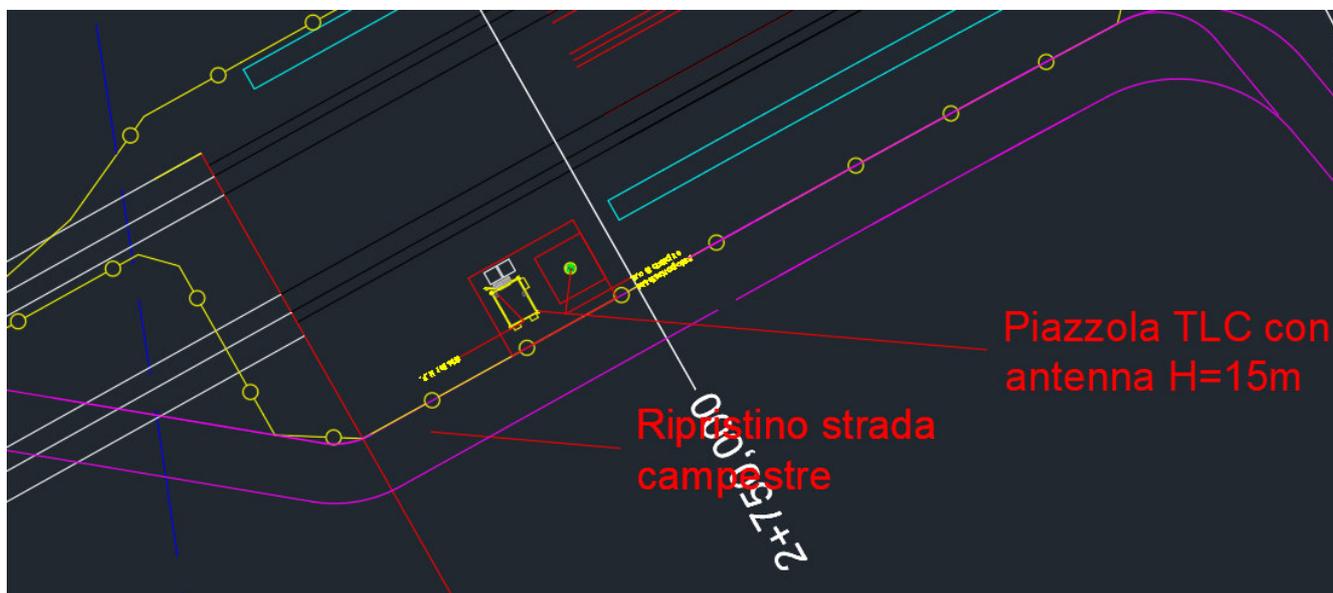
Stralcio planimetria con evidenza inserimento palo
